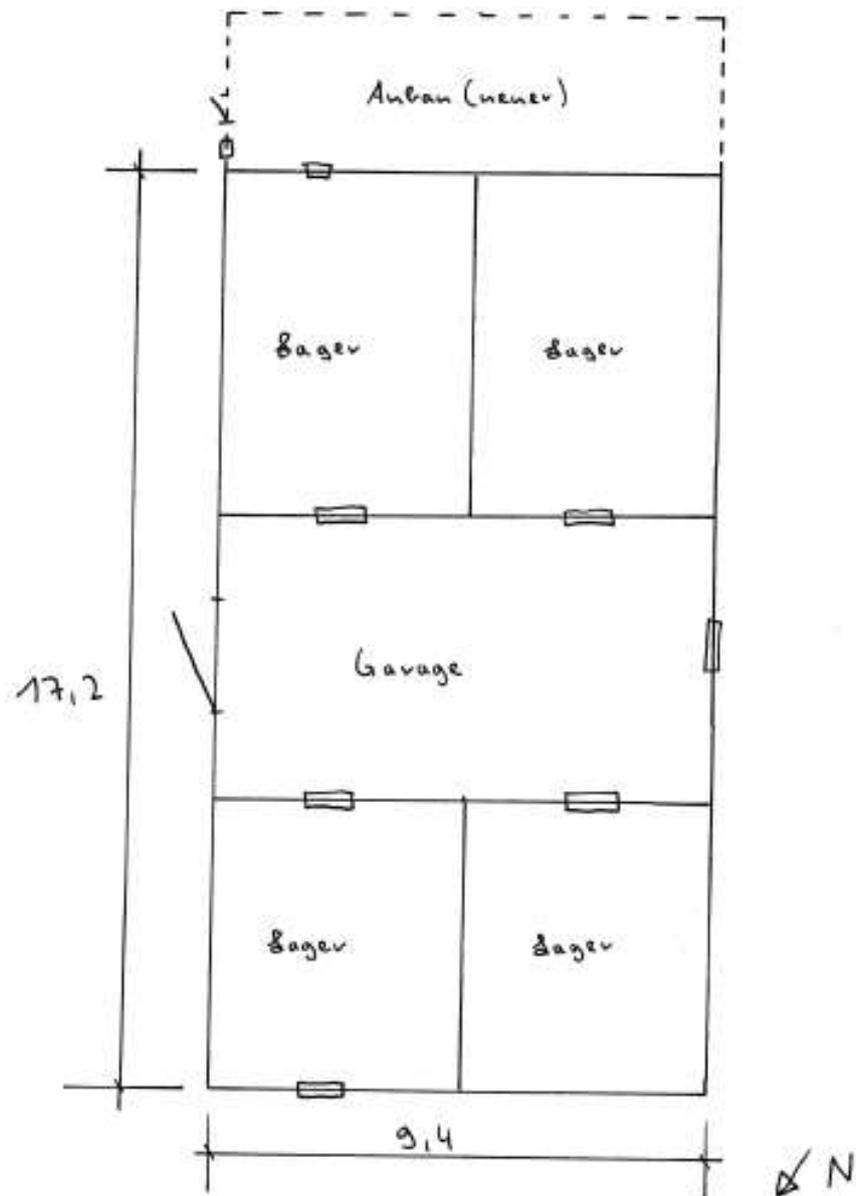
Grundriss Stall Oberkainz OG
